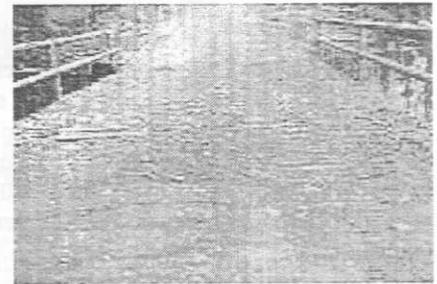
Base estabilizada en mal estado. Puente El Sábalo (Putumayo).
